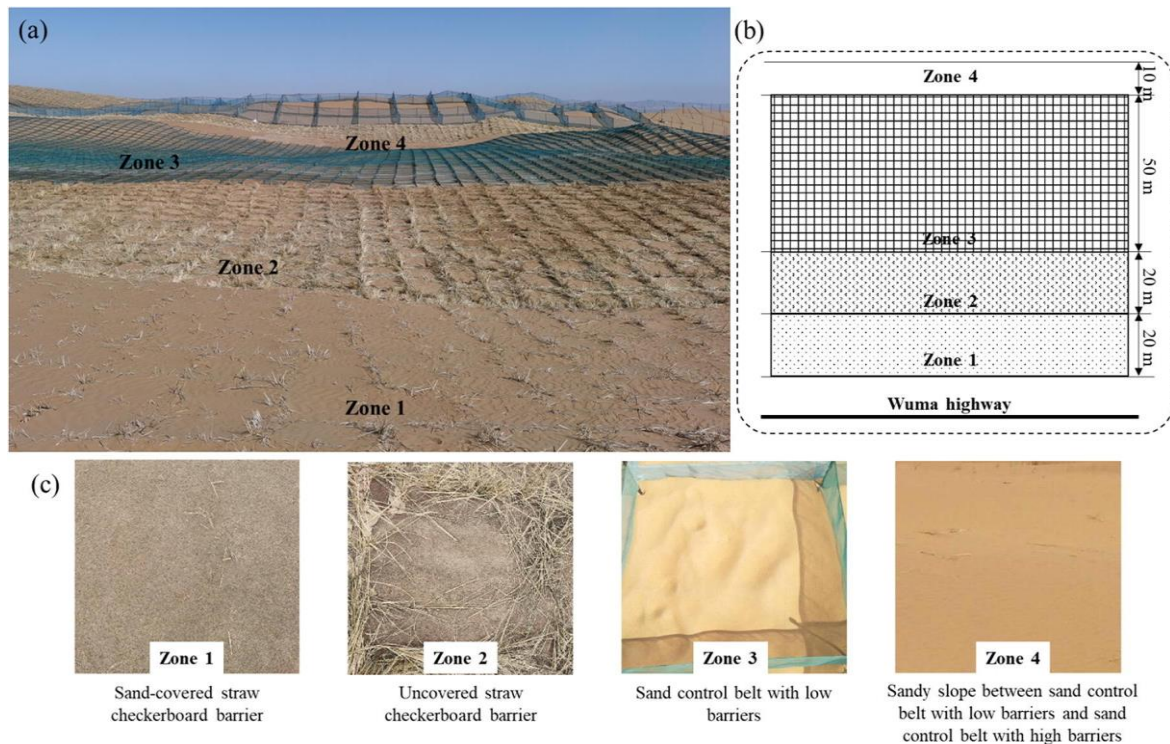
Site d'essai sur le terrain : (a) zones d'essai 1 à zones d'essai 4 sur le site d'essai sur le terrain ; (b) croquis en plan des zones d'essai 1 aux zones d'essai 4 : (c) les caractéristiques géomorphologiques spécifiques des zones d'essai (Sun et al., 2021).
